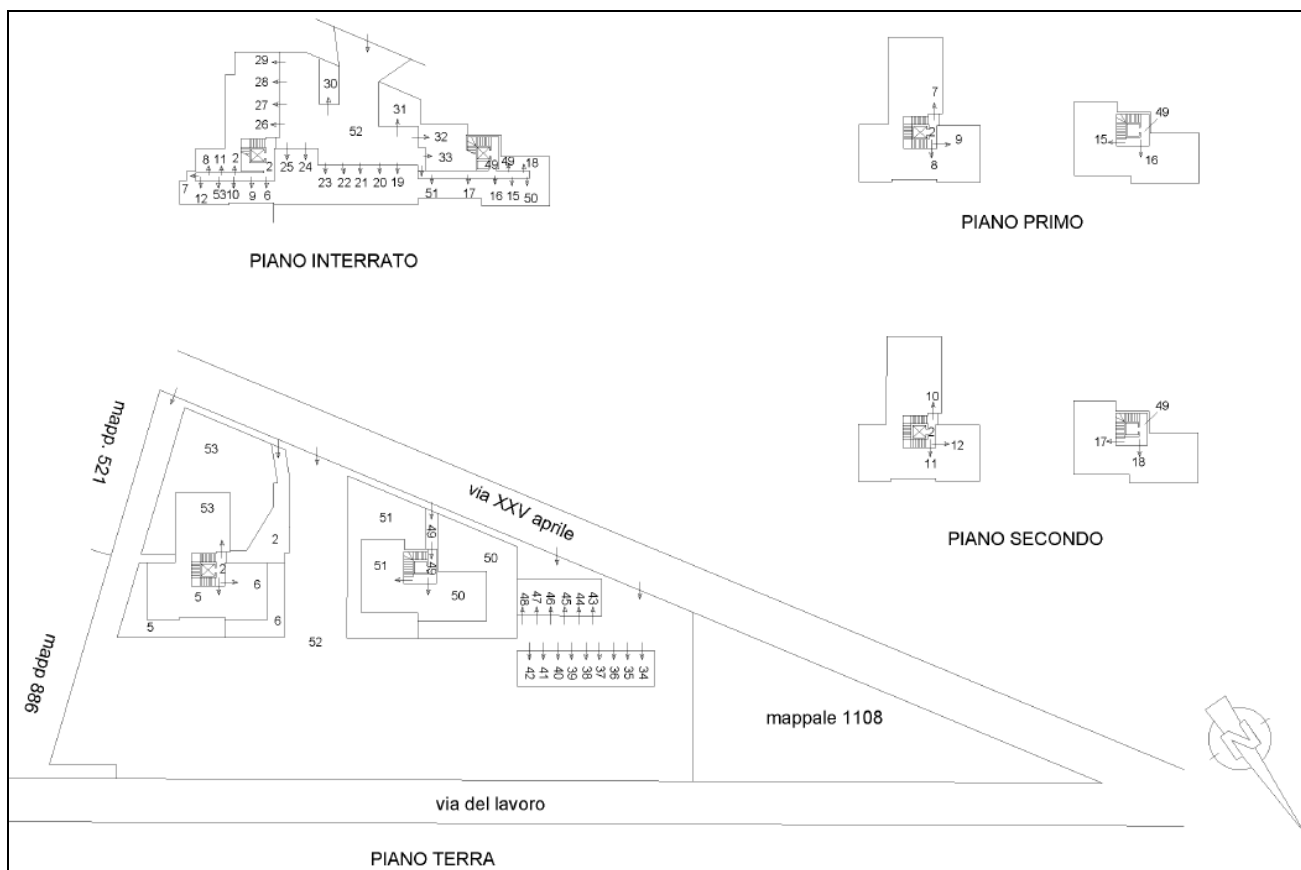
Estratto planimetria del complesso immobiliare ([Allegato N.4](#))
